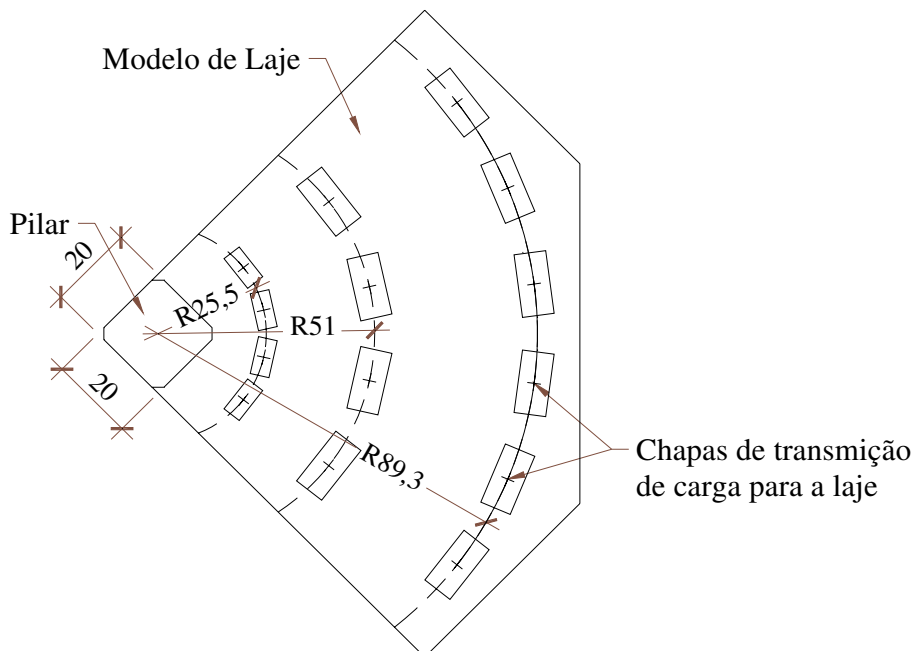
Planta do modelo de ensaio utilizado por FIGUEIREDO/1983
